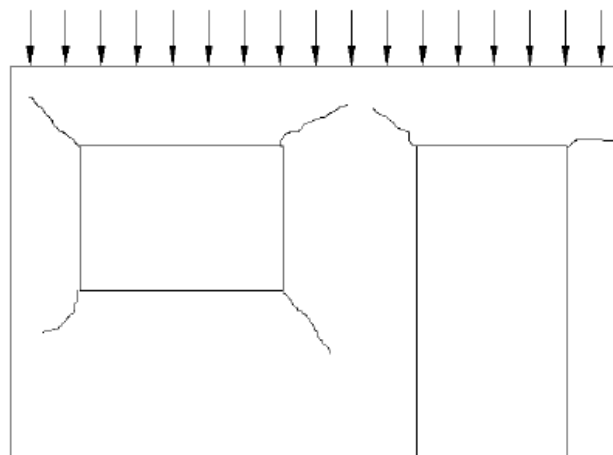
Fissuração típica nos cantos das aberturas sob atuação de sobrecargas (THOMAZ, 1989)
